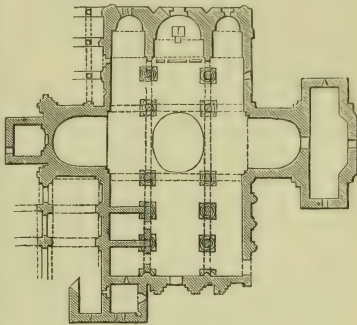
Grundriss der Kirche zu Routhais.
